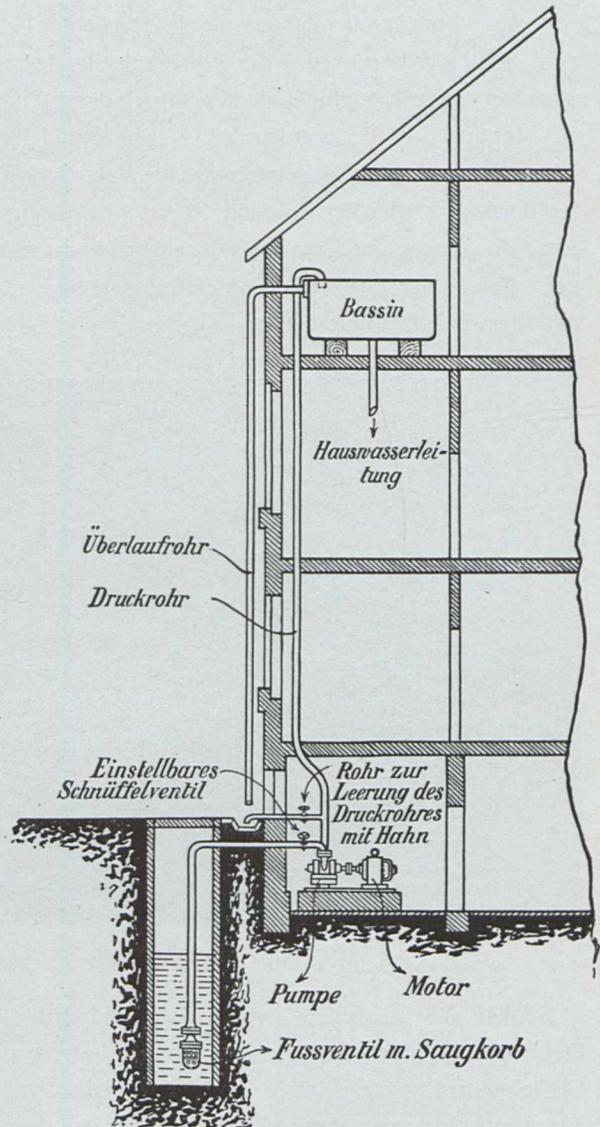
Schema einer elektrischen Hauswasserpumpe mit Rohrleitung, Brunnen und Wasserbehälter.
